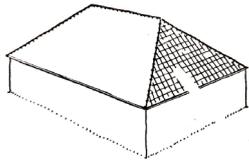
| Vollwalmdach auf langgestrecktem Grundriss, Heckl 1949, 48
